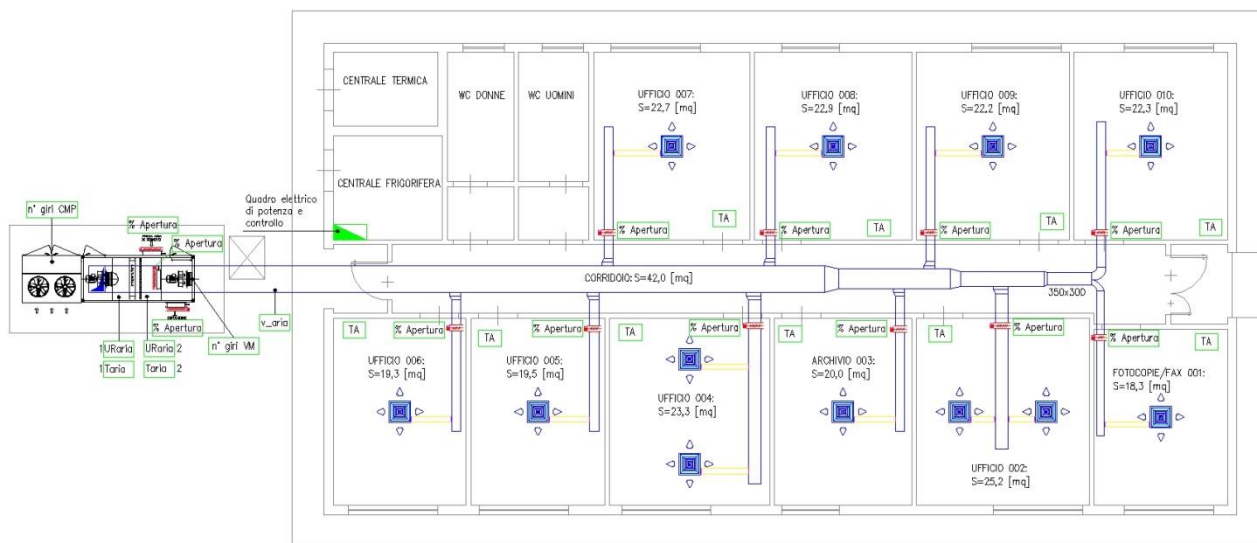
Layout distribuzione aria impianto con PDC aria-aria (roof top)
